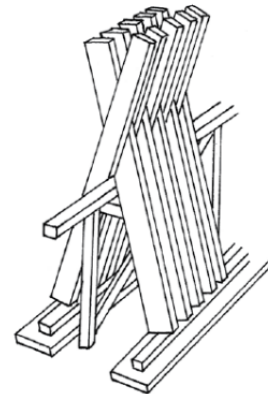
Apilado de la madera en caballete, tomada de CITEmadera⁴³
